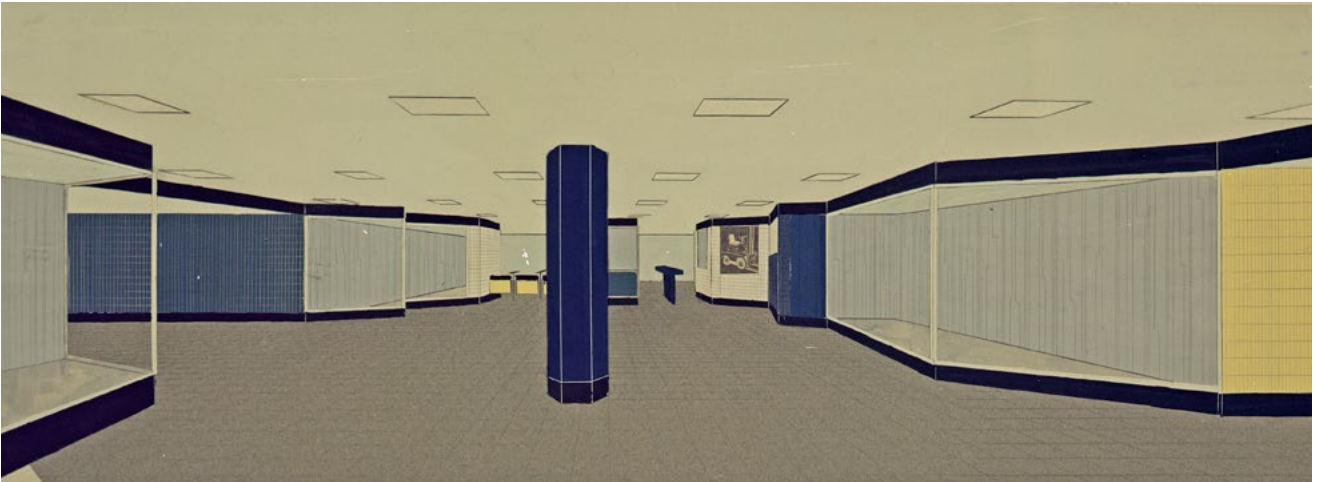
Hamburg, Wandsbeker Linie, U-Bahnhof Wandsbeker Chaussee, Ladenpassage im Zwischengeschoss. Entwurfscollage Fritz Trautwein, 1961
